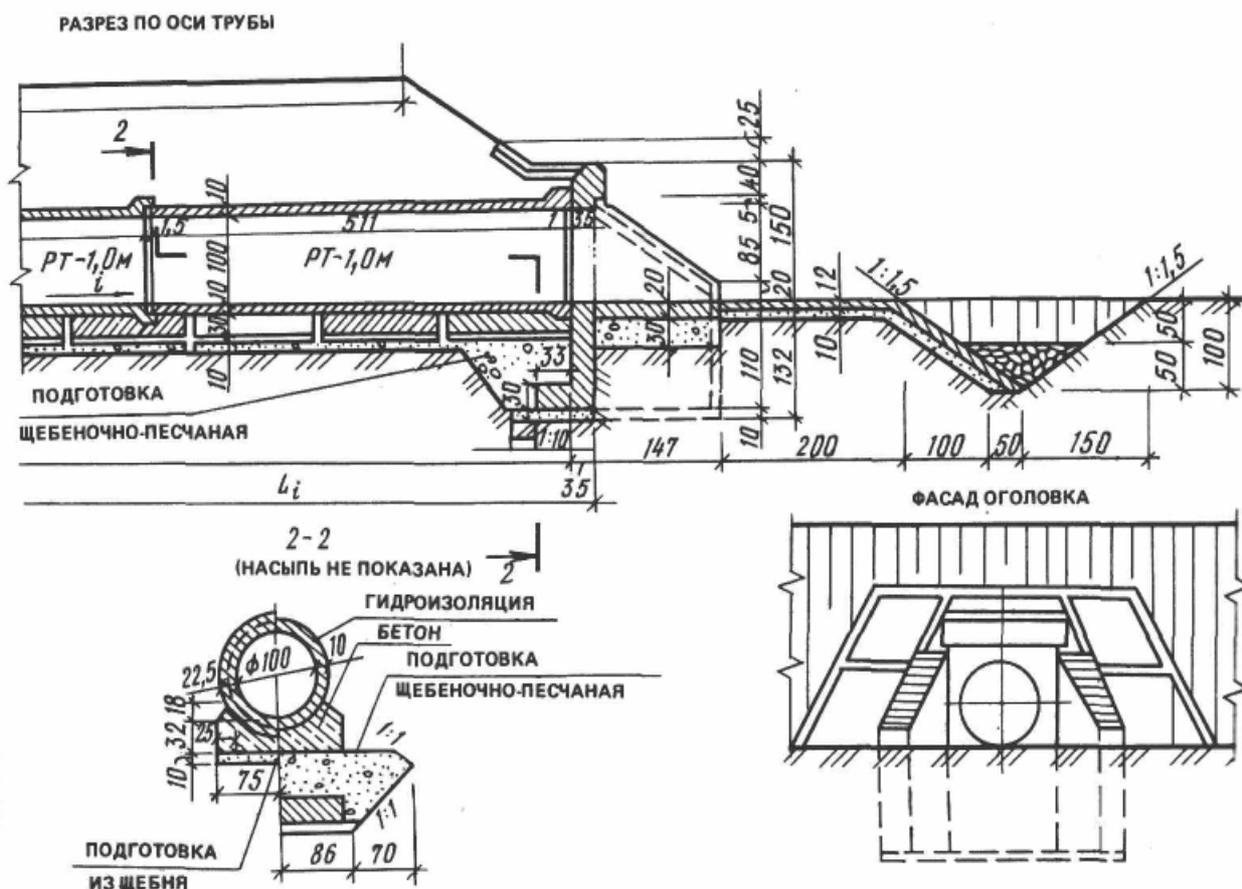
Пример оформления чертежа круглой железобетонной сборной трубы
